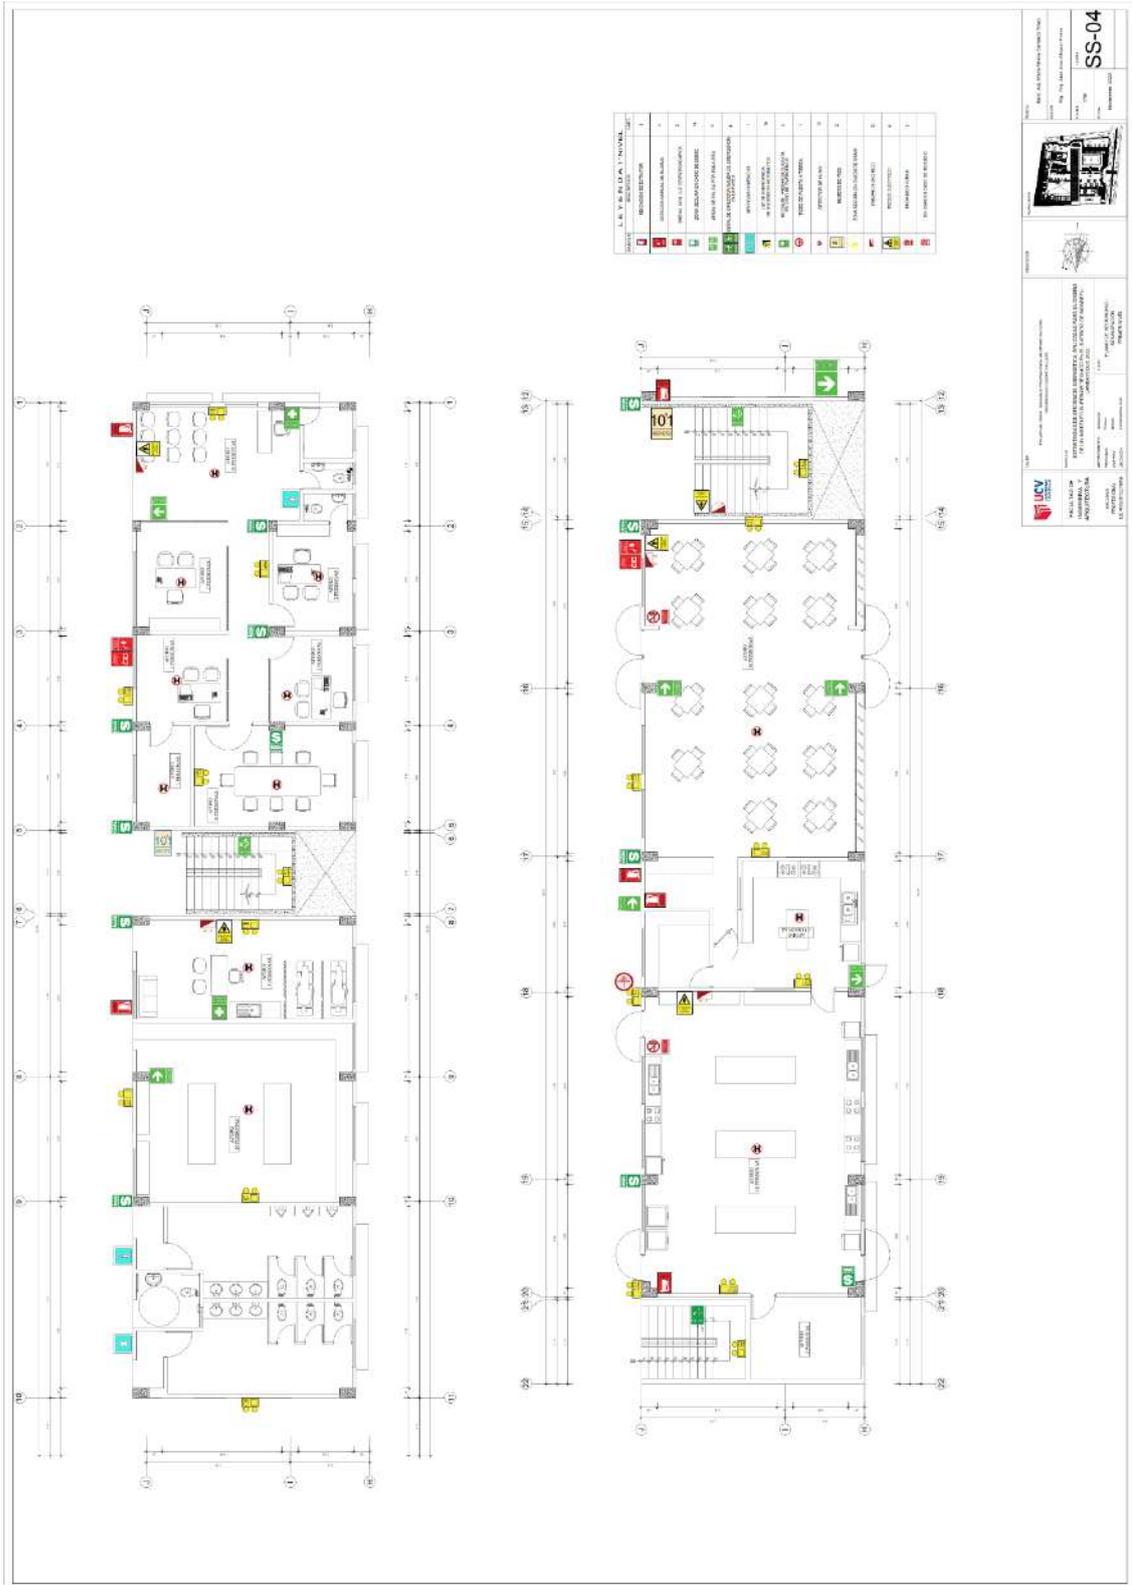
Plano de Señalética – Sector 1 Primer nivel
